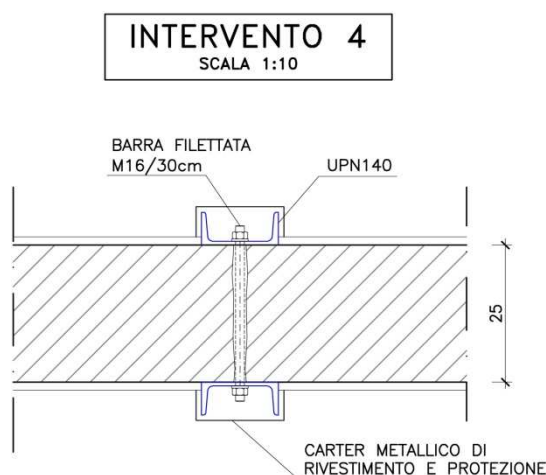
Schema Intervento 4 – Stabilizzazione pareti longitudinali interne
